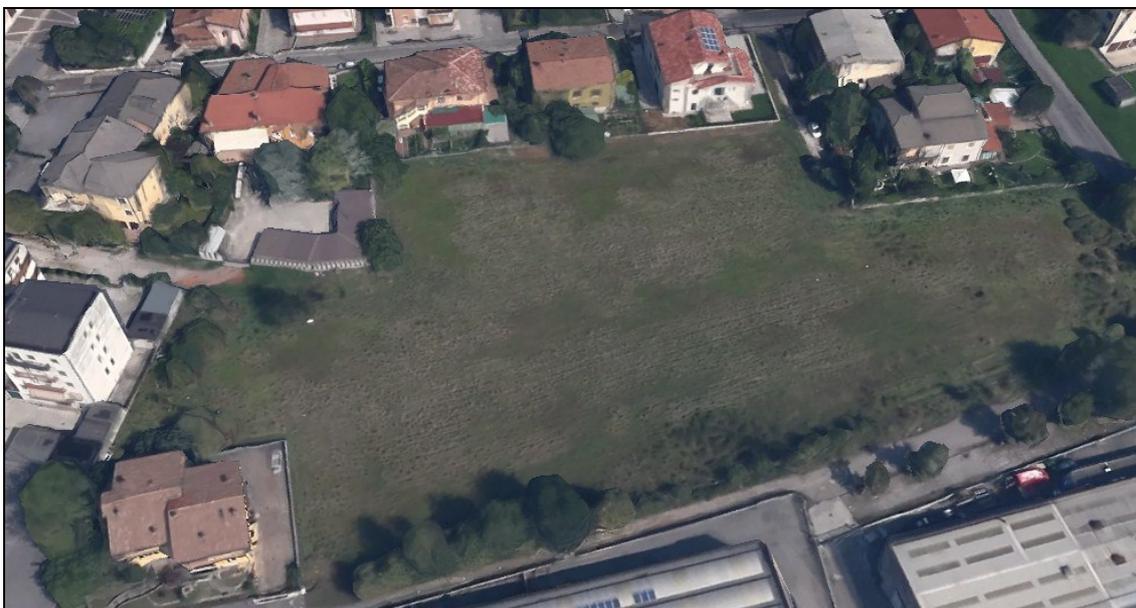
Vista Stato attuale area oggetto dell'intervento (Stato di fatto)
